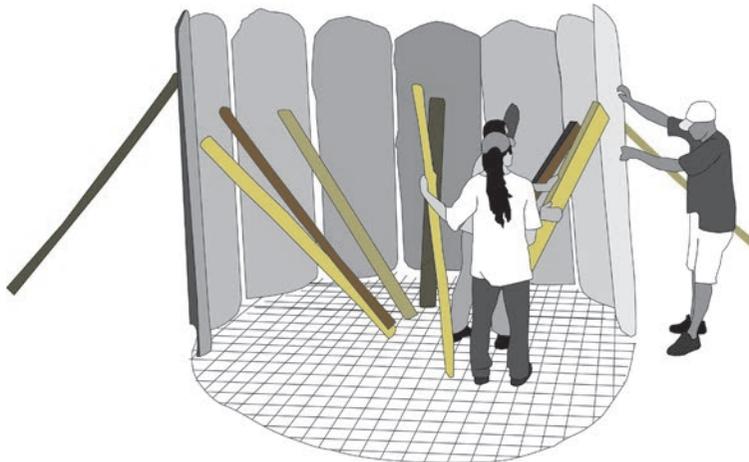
Cimbramento provisório das peças pré-fabricadas no local de elevação da cisterna.
